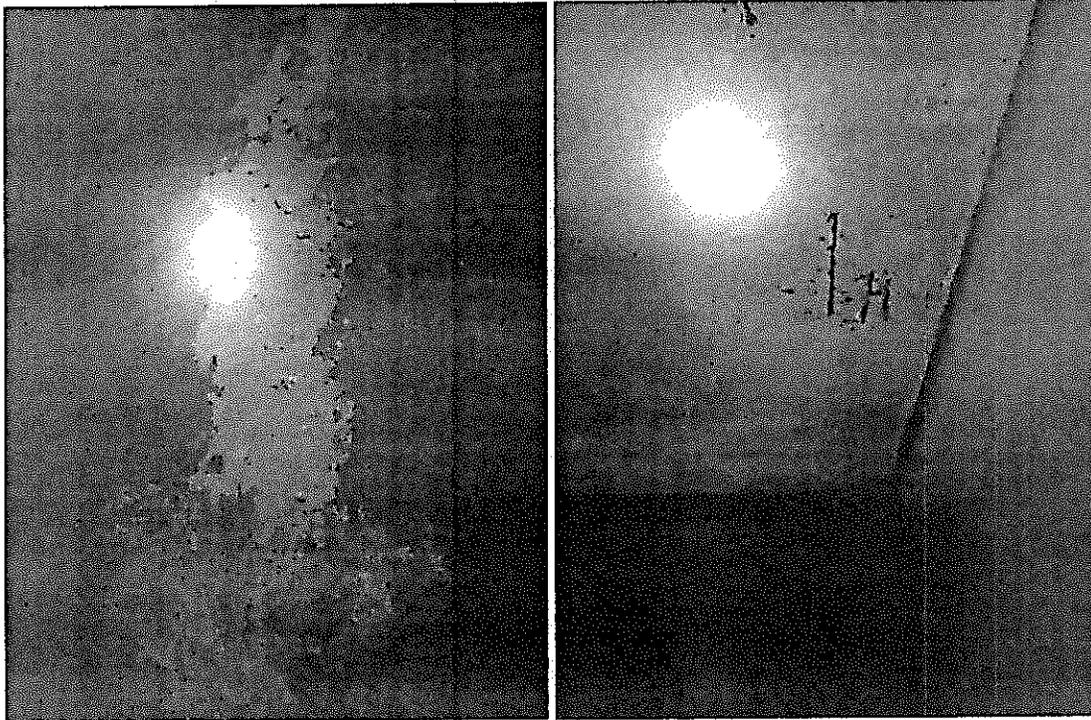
(Izq.) Reparación locativa en fisuras. (Der) Exposición del acero de refuerzo en la losa de cubierta. "fuente propia".
